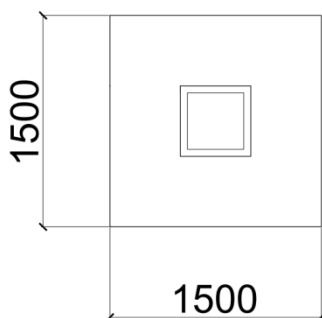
Фундамент под среднюю колонну
